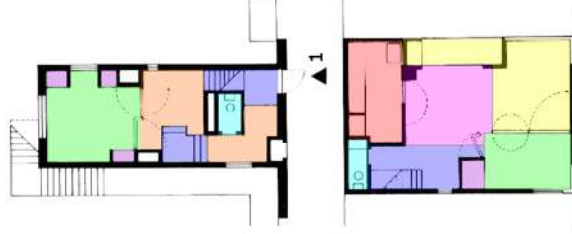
Fragmento da Planta do 1º Pav. E: 1/200
